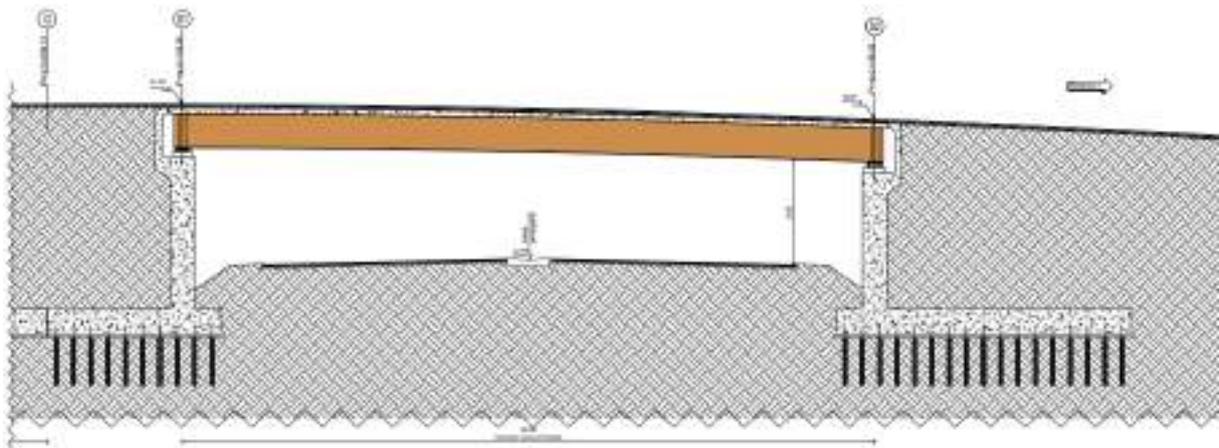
Sezione longitudinale del cavalcavia asse principale svincolo Capoterra – Casci.
